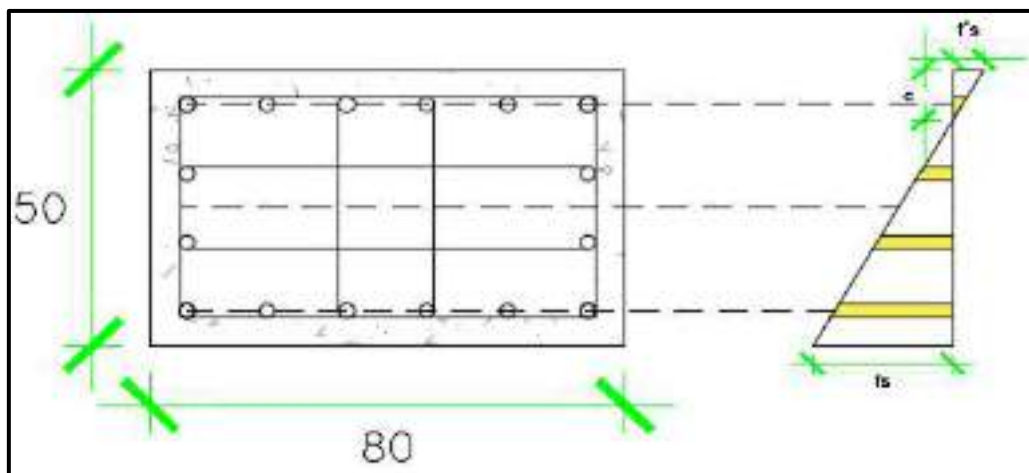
Falla por tracción en la pila en la dirección transversal del puente
